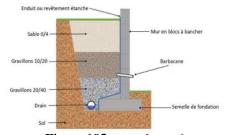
mur de soutènement Source : toutsurlebeton.fr
